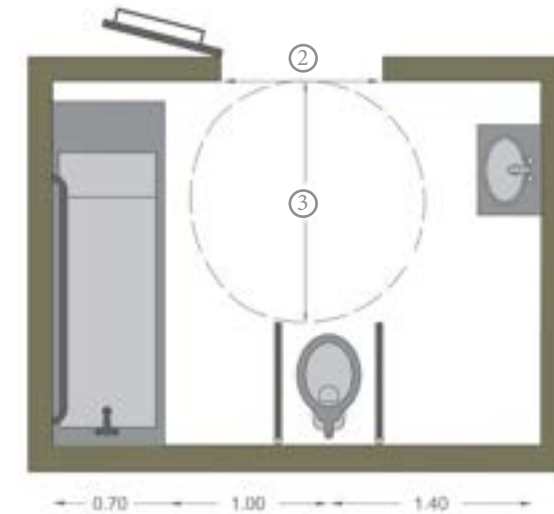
3 Baño con dos áreas de transferencia - Planta
